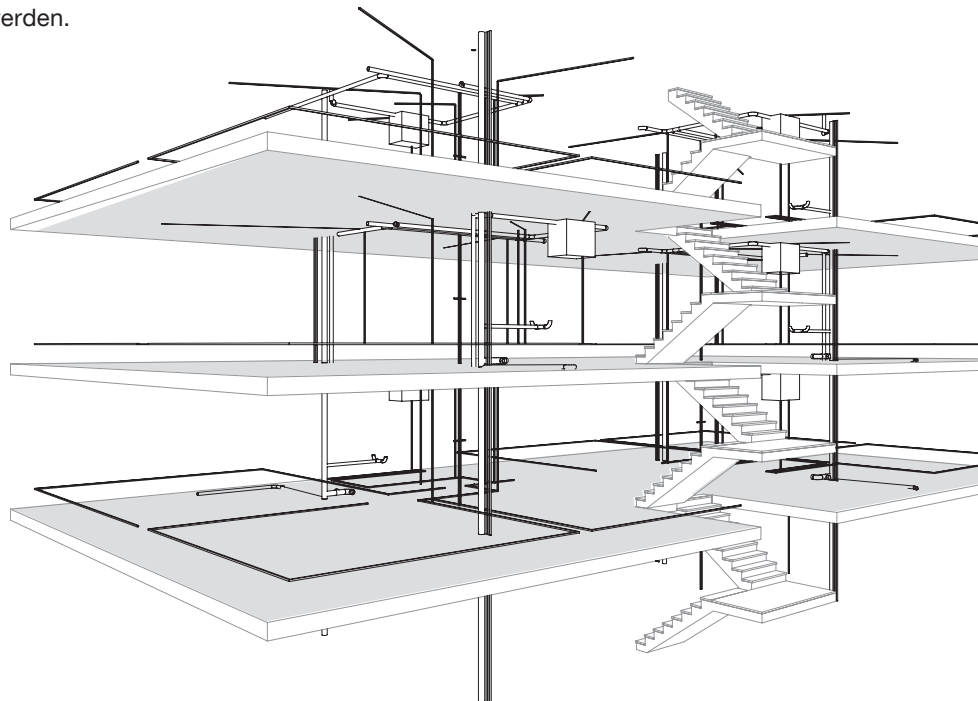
Heute übliche Trassenvielfalt und Verflechtung im Gebäude bei weit auseinanderliegenden Nassbereichen oder individuellen Grundrissen
